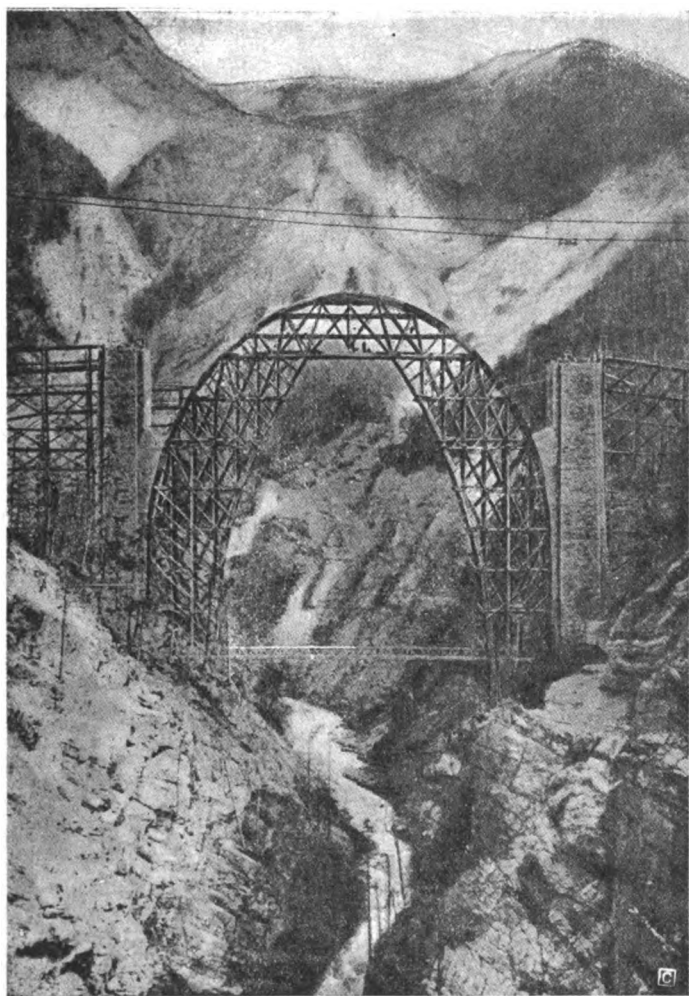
Il viadotto di Wiesen della Ferrovia Davos-Filisur. Vista in costruzione.
